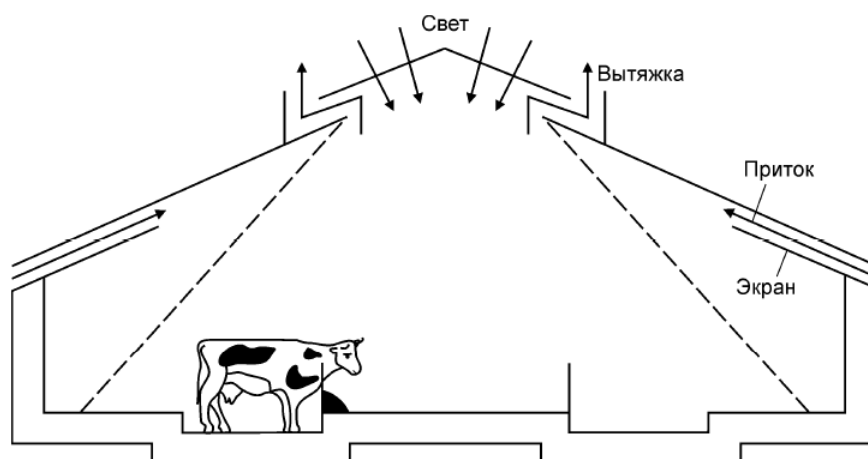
Схема естественной вентиляции коровника с притоком через боковые стены и вытяжкой через светоаэрационный конек в кровле
